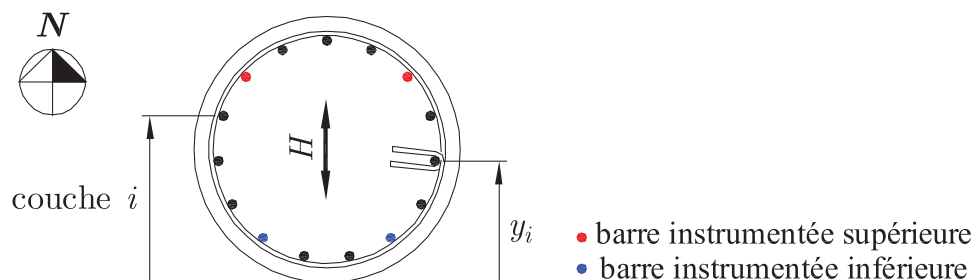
Section du pilier CH300 et barres d'acier longitudinales instrumentées.
